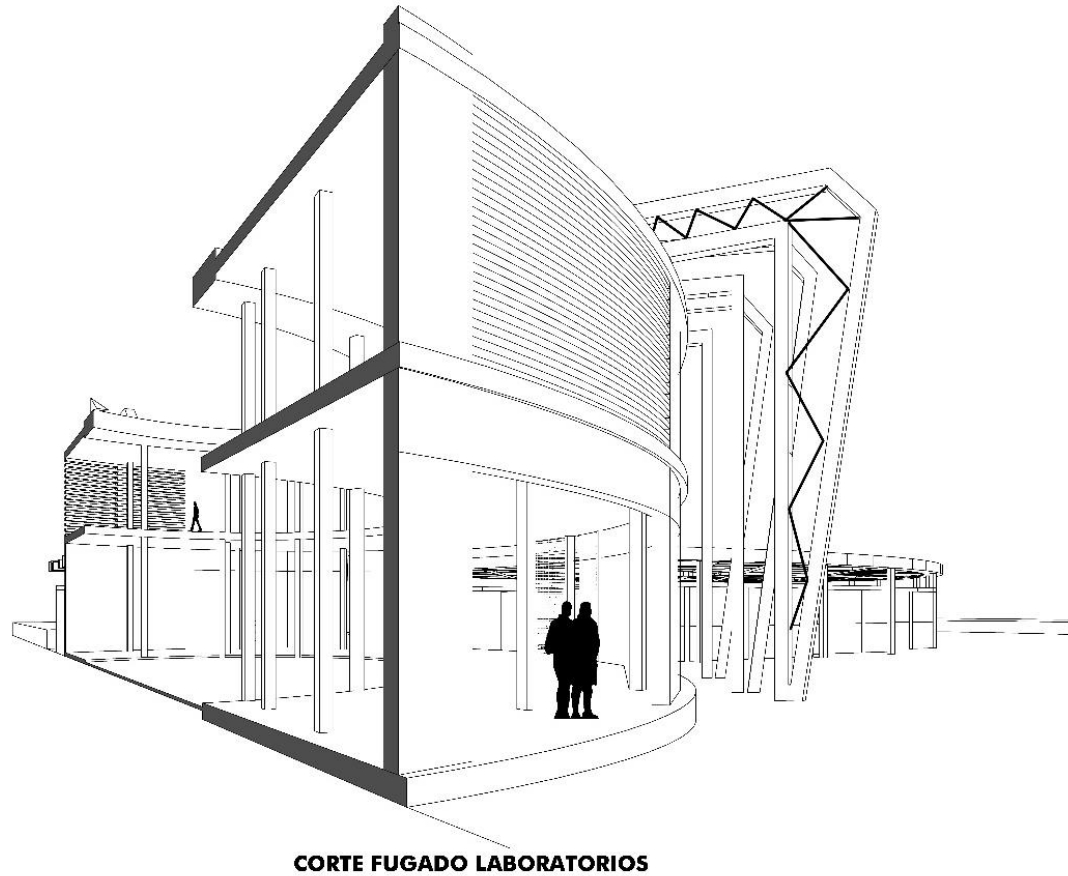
Corte fugado Laboratorios. Fuente : Elaboración propia
